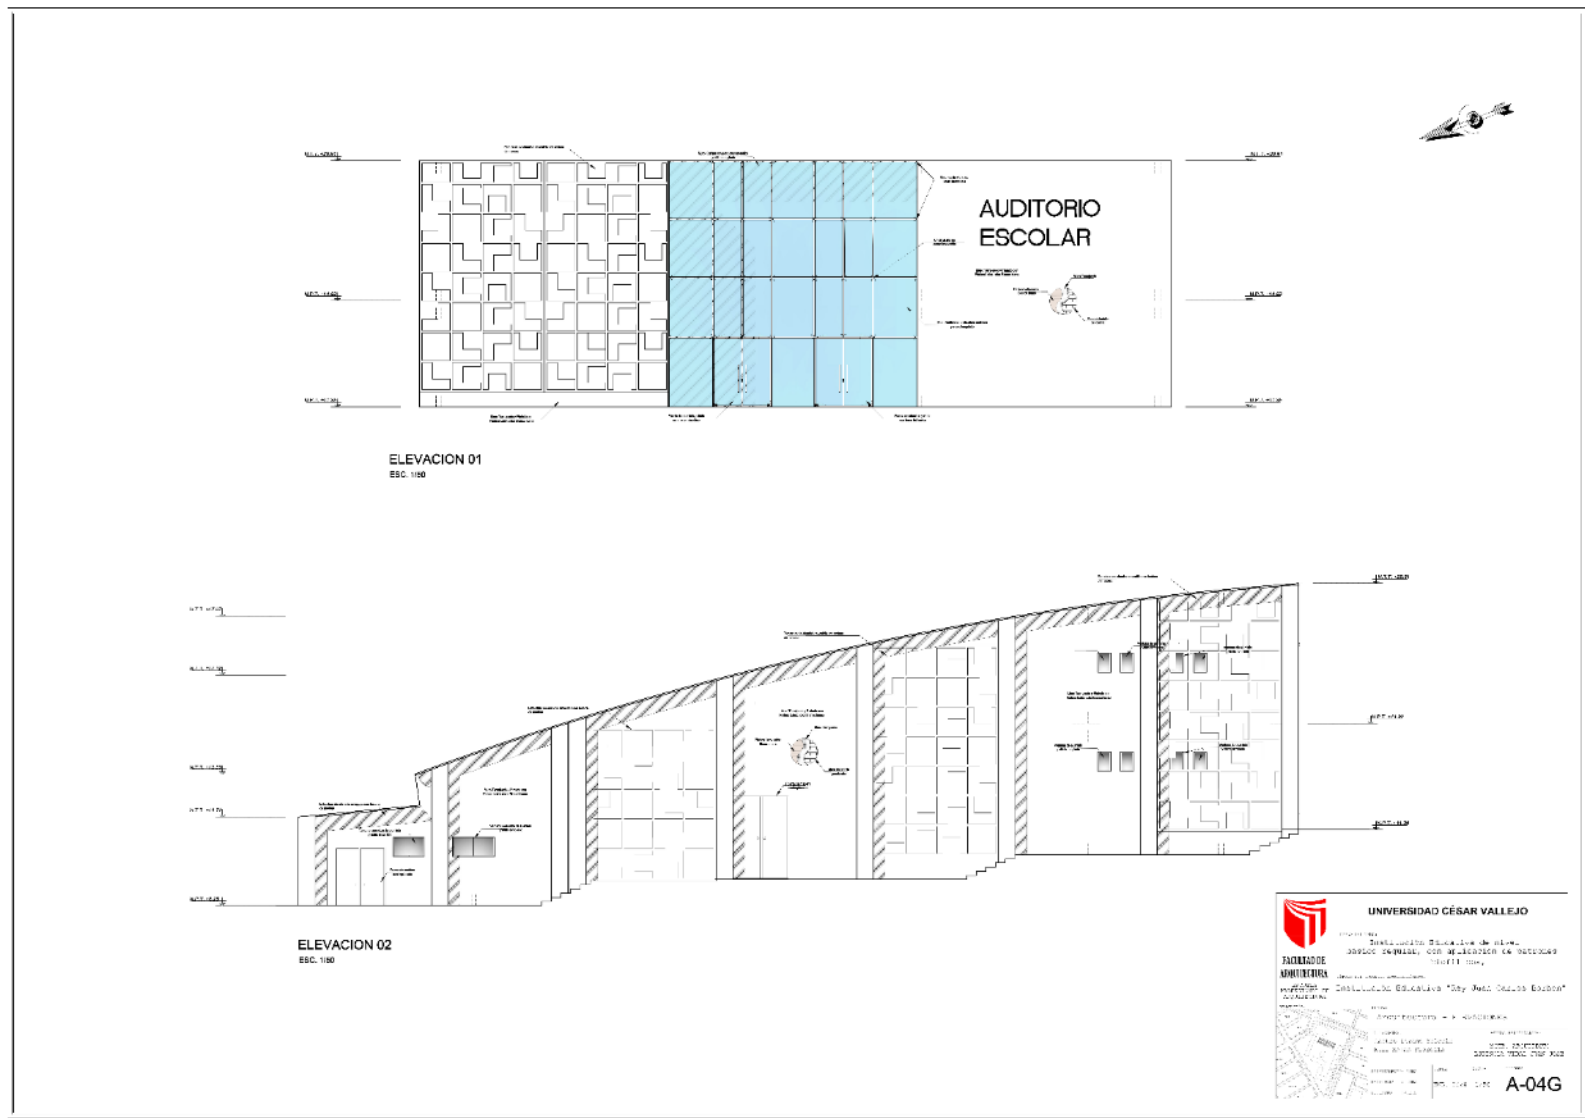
Plano Elevaciones Bloque "G", Fuente: elaboración propia
